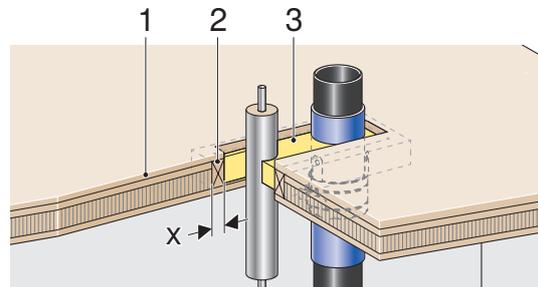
Ausführung des Deckendurchbruchs mit im Holzbau geprüften Abschottungssystemen
